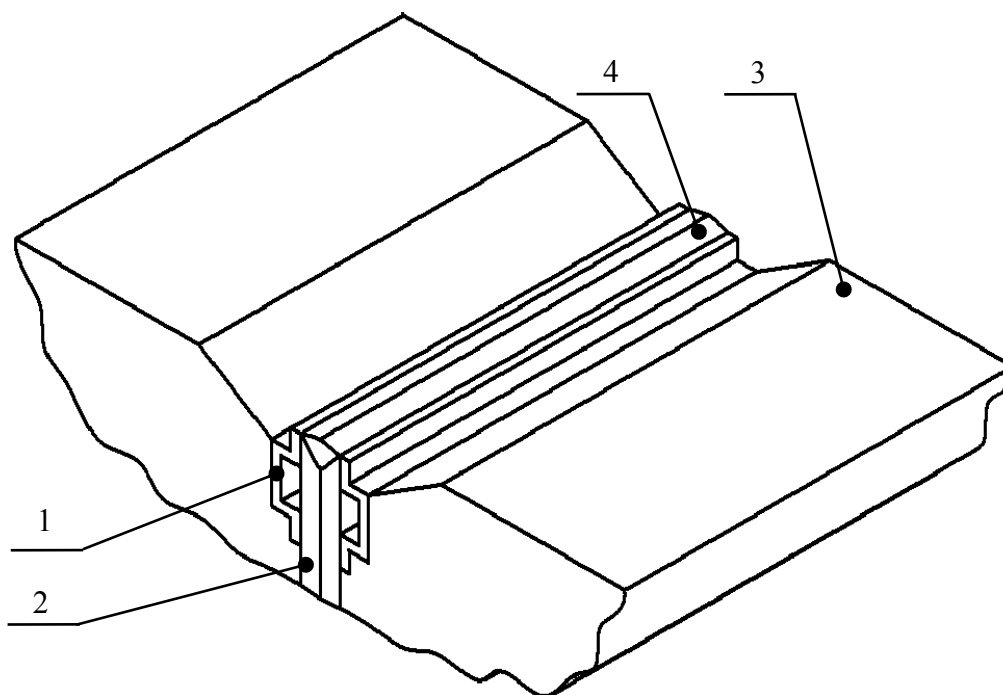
Вариант исполнения краевого монтажного стыкового сварного соединения с отбортовкой формообразующих листов: 1 – защитная пластина; 2 – формообразующий лист; 3 – бетонный заполнитель; 4 – сварной шов
